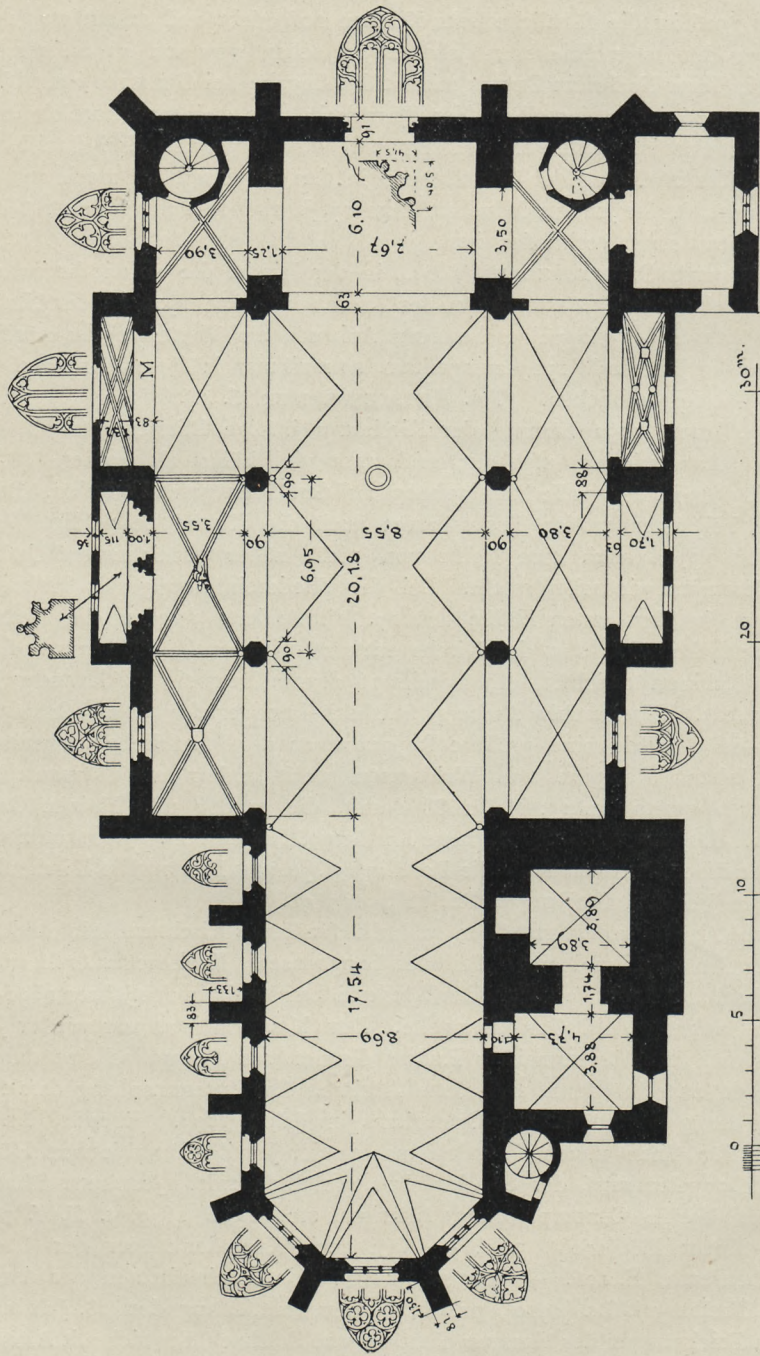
Sulzbach. Grundriß der Pfarrkirche.
